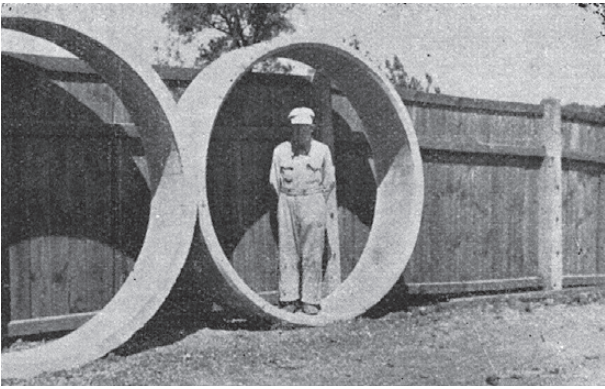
Formy do badań przyczepności betonu do zbrojenia w badaniach W. Paszkowskiego [6]
